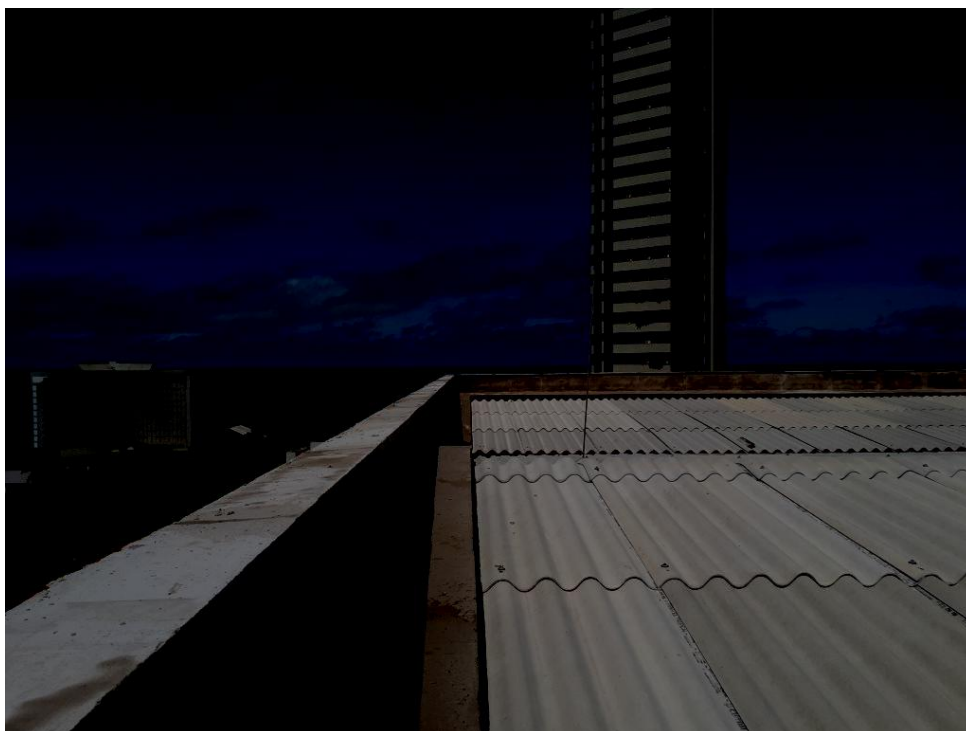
Vista geral da laje de cobertura. Platibanda, calha de drenagem e madeiramento da cobertura executados e telhas instaladas.
